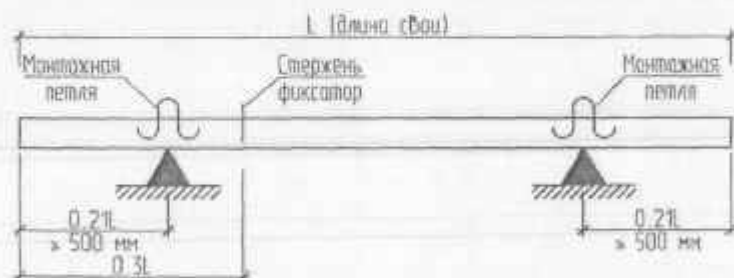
Схема испытаний предварительно напряженных железобетонных свай
